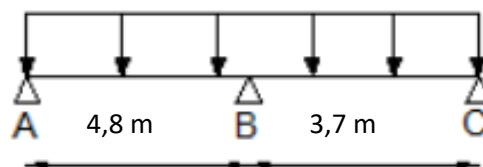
Schéma statique de la poutre reposant sur trois appuis.
